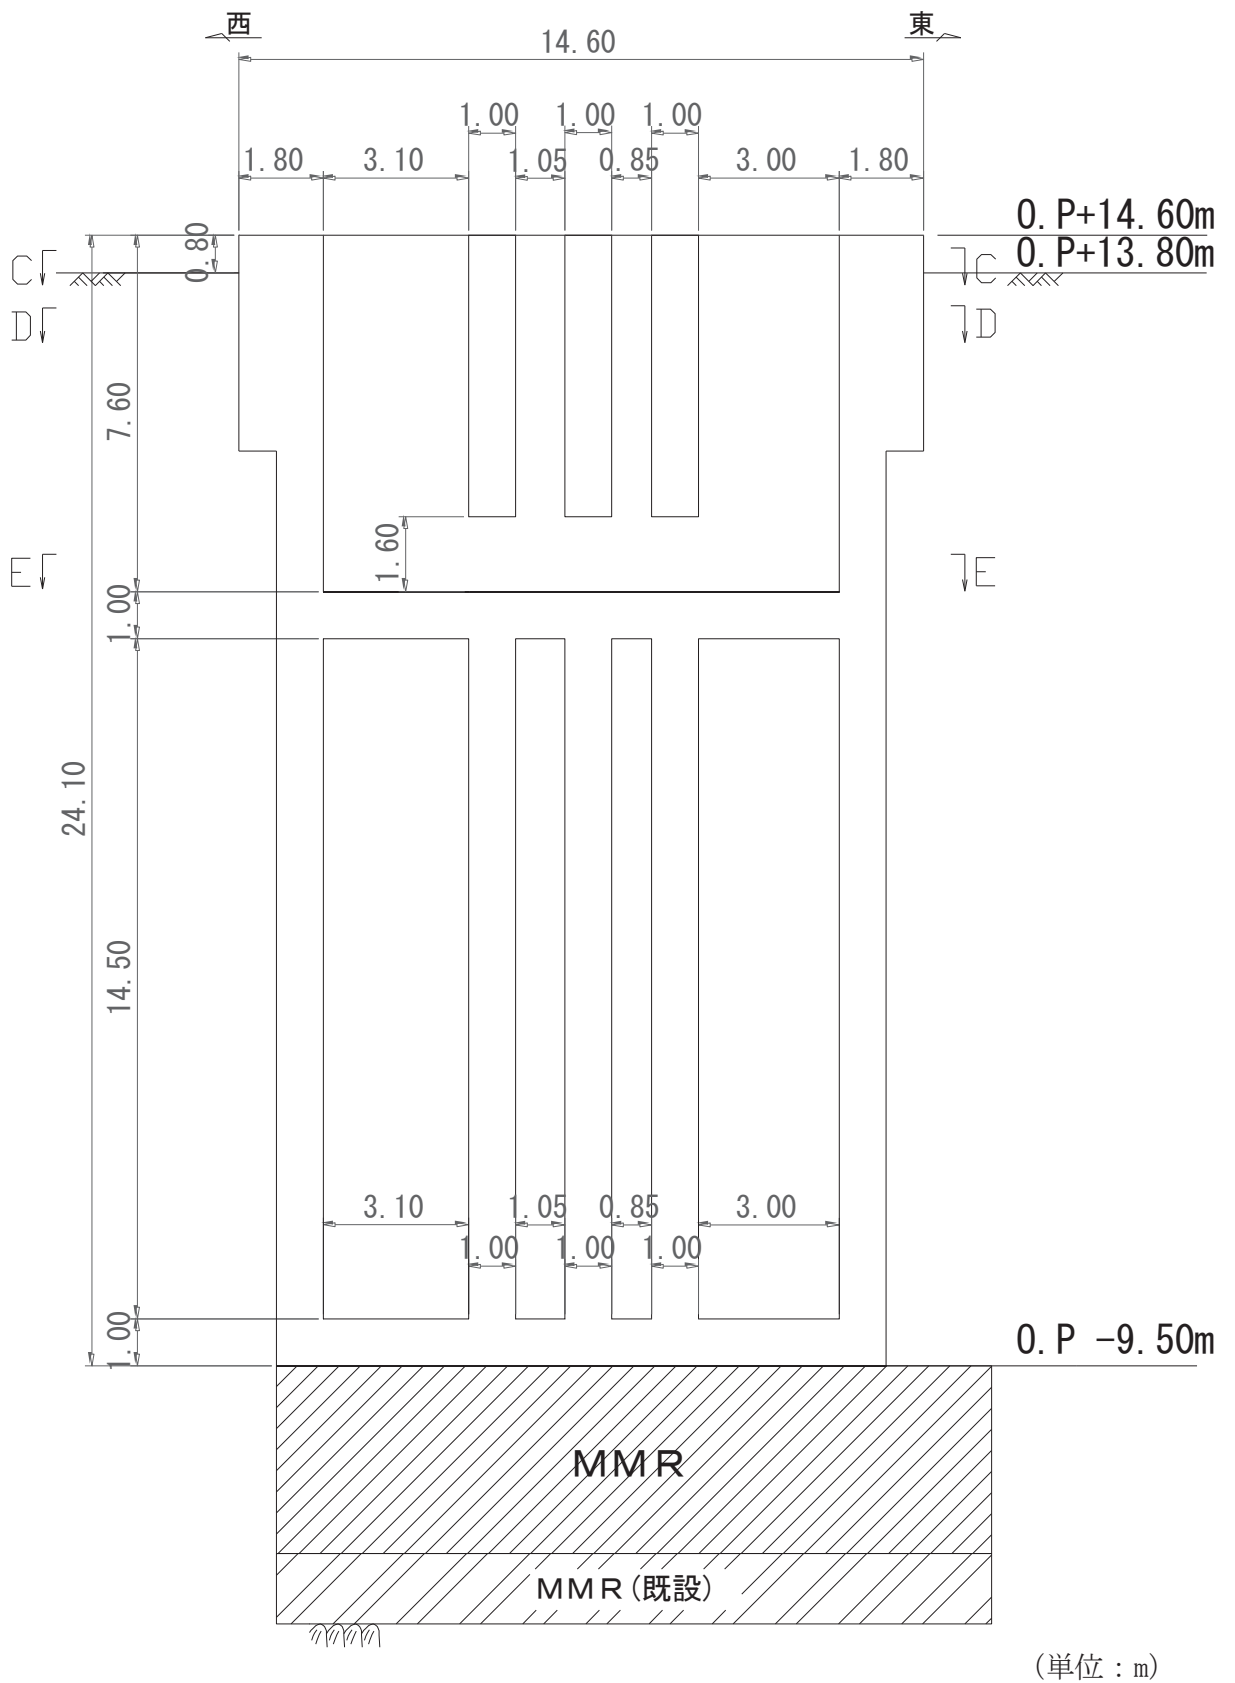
第 3 号機補機冷却海水系放水ピット縦断面図 (A-A 断面)
